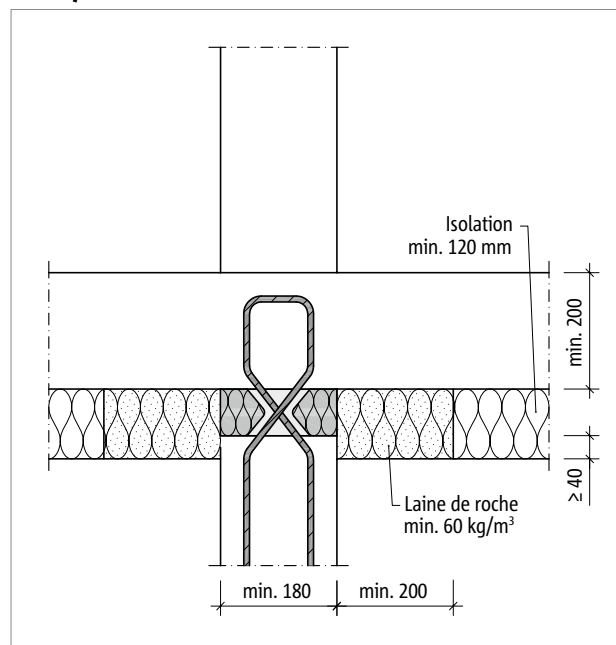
Schöck Sconnex® type W-N-VH : avec bande de bordure en laine de roche dans la zone de l'isolation sous la dalle
